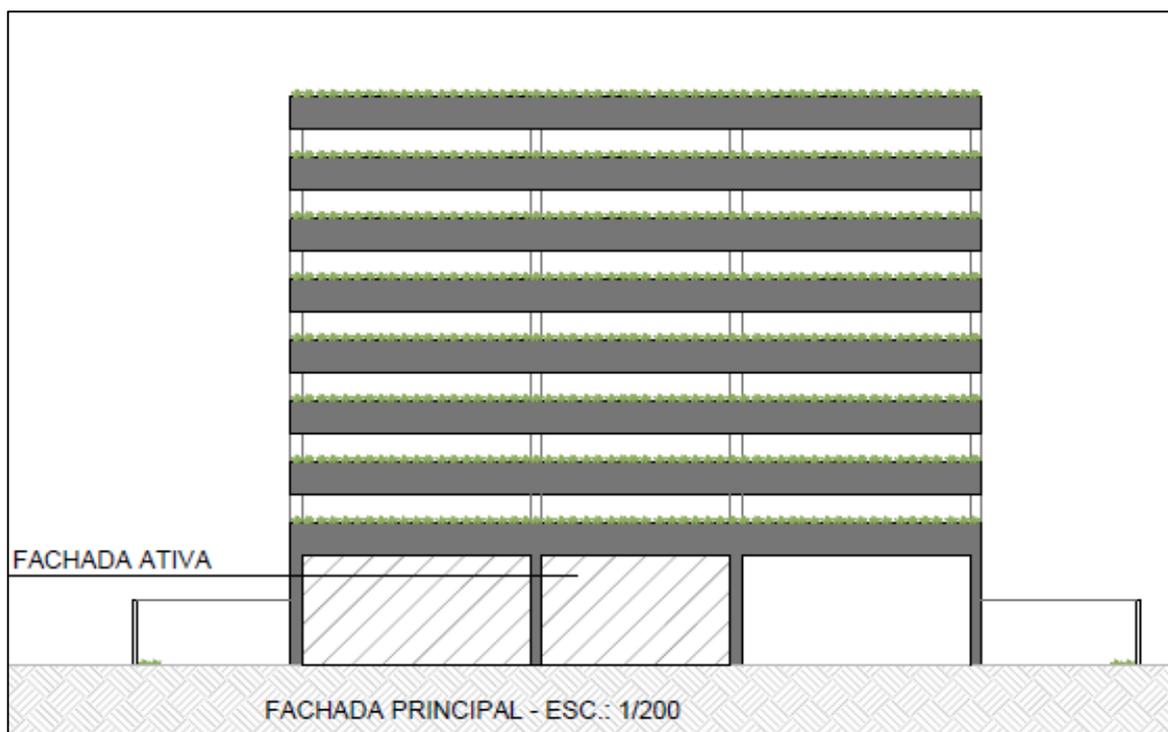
Elevação da fachada frontal (Av. Vital Brasil).
